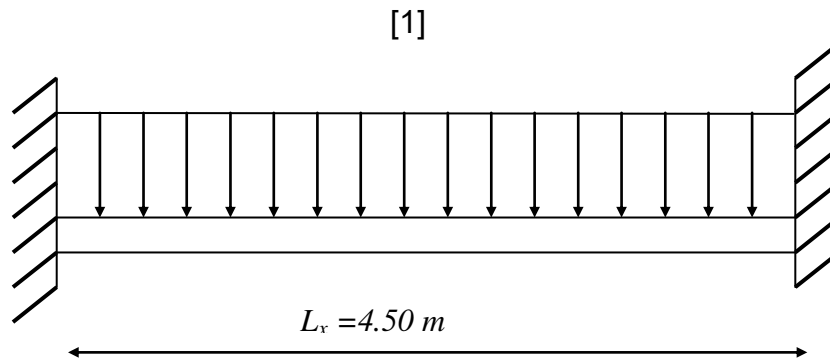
Schéma statique de la poutrelle – Encastrée -
